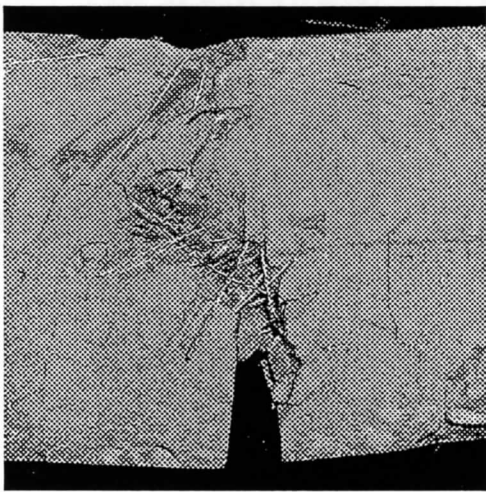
切り欠き先端のひび割れ状況 (SC40-1)
